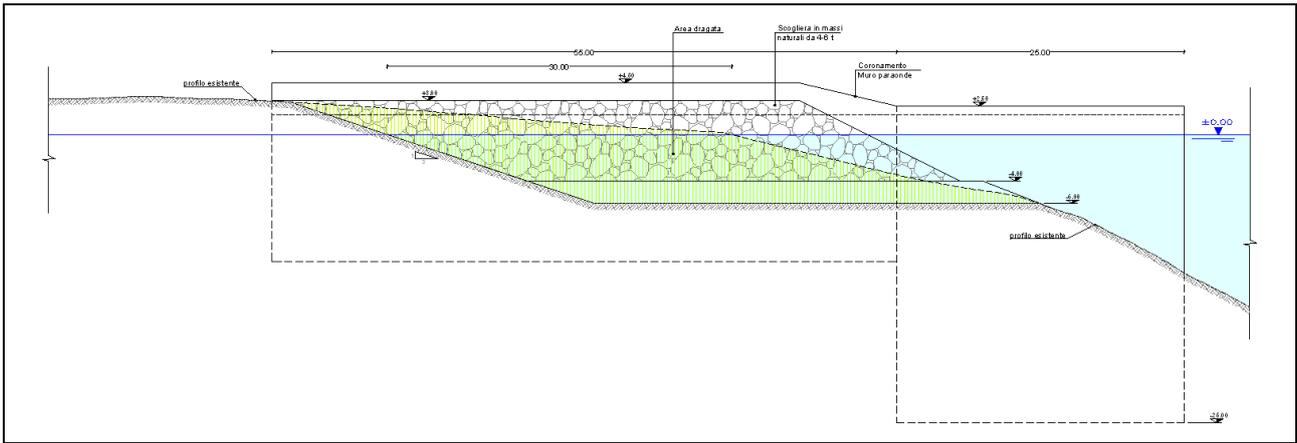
Sezione tipica del dragaggio in prossimità del pennello (sezione A'-A').
